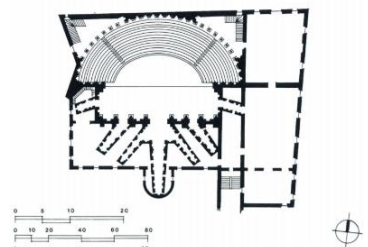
Teatro Olímpico, planta (Rooth, 2017)
